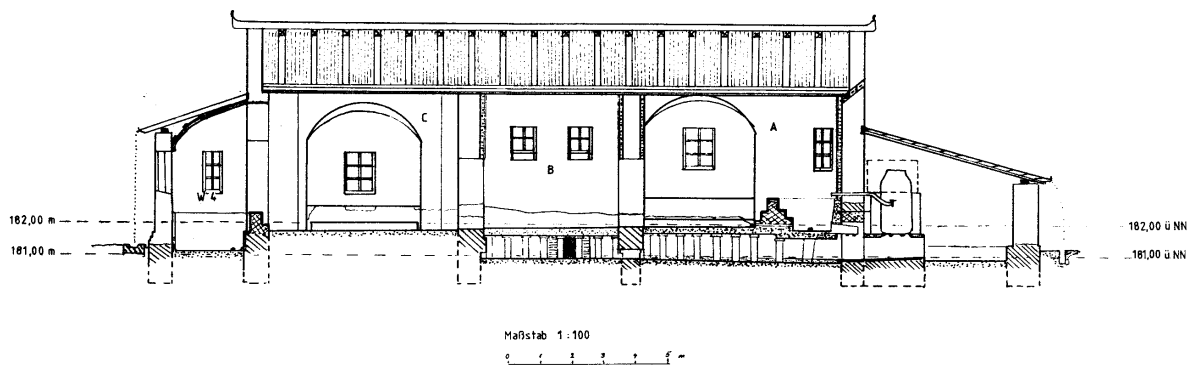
Rekonstruktionsversuch (Schnitt durch die Hauptbaderäume)
